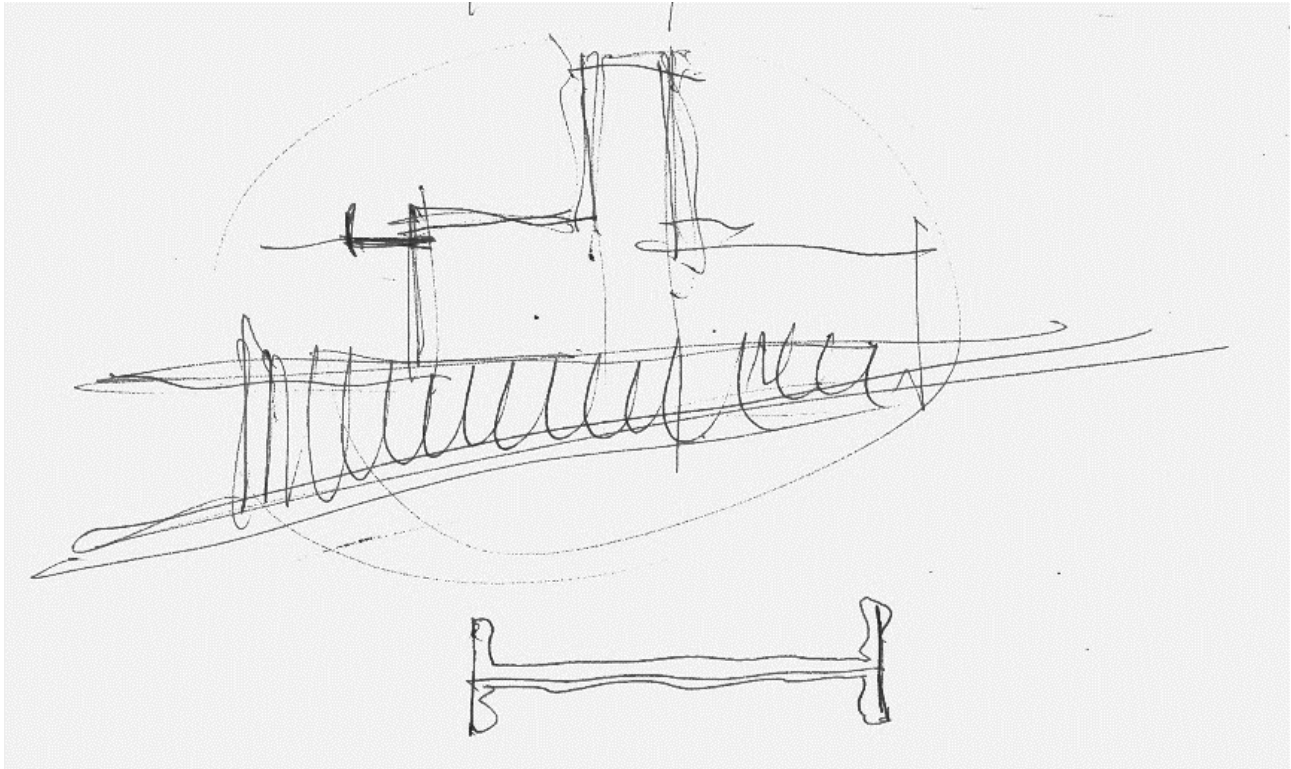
Vivienda López Rey, planta subsuelo y planta principal.
